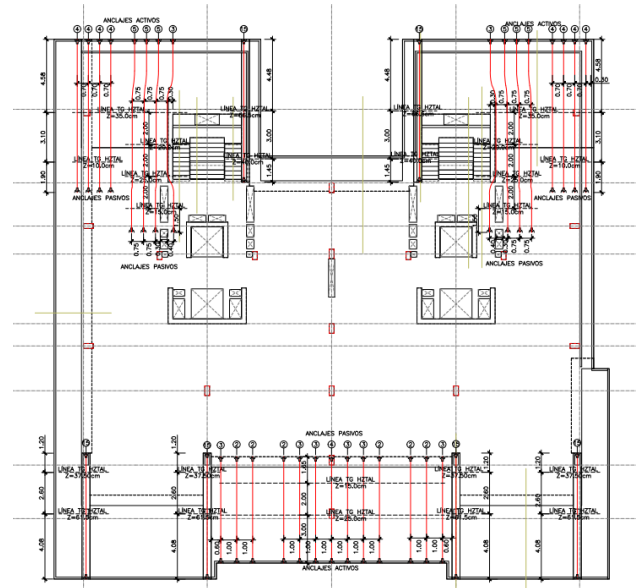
Disposición de armadura activa en los forjados en la zona de voladizos.
